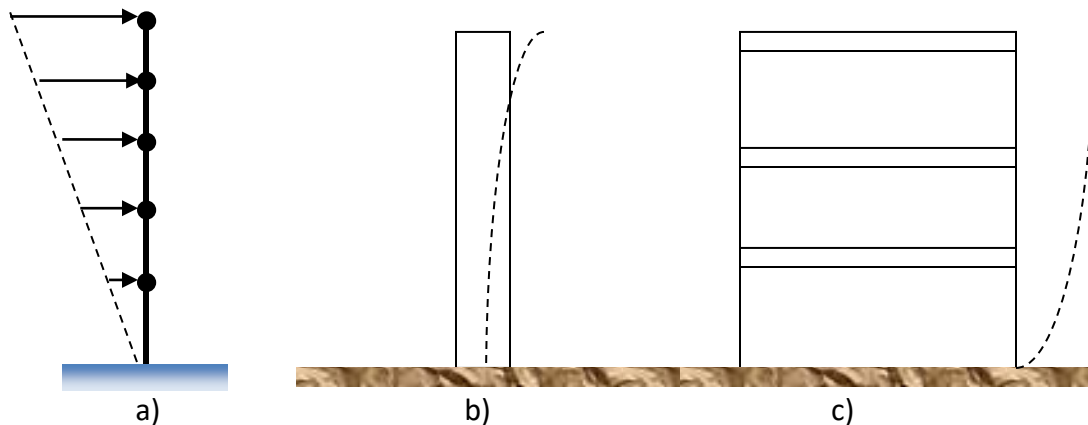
Distribuzione di forze assunta dalla normativa (a); deformata a mensola di strutture con comportamento del tipo a mensola b); deformata “shear type” di un telaio pluriplano c)
